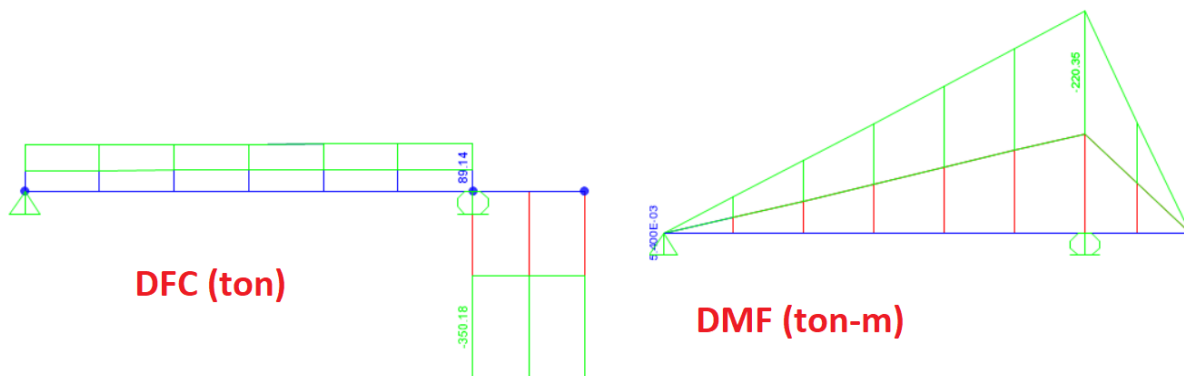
Diagrama de fuerzas internas para la viga de cimentación
